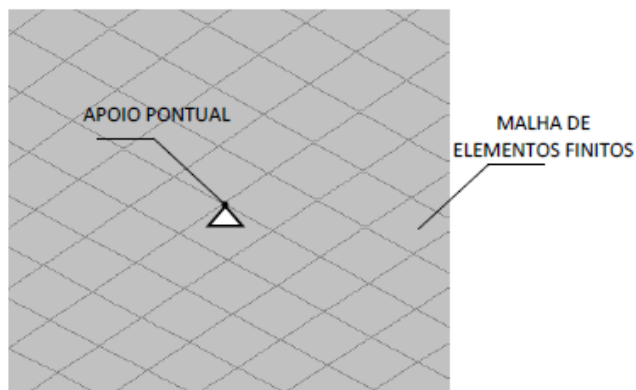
Laje Lisa apoiada em apoio pontual (LONGO, 2008)
